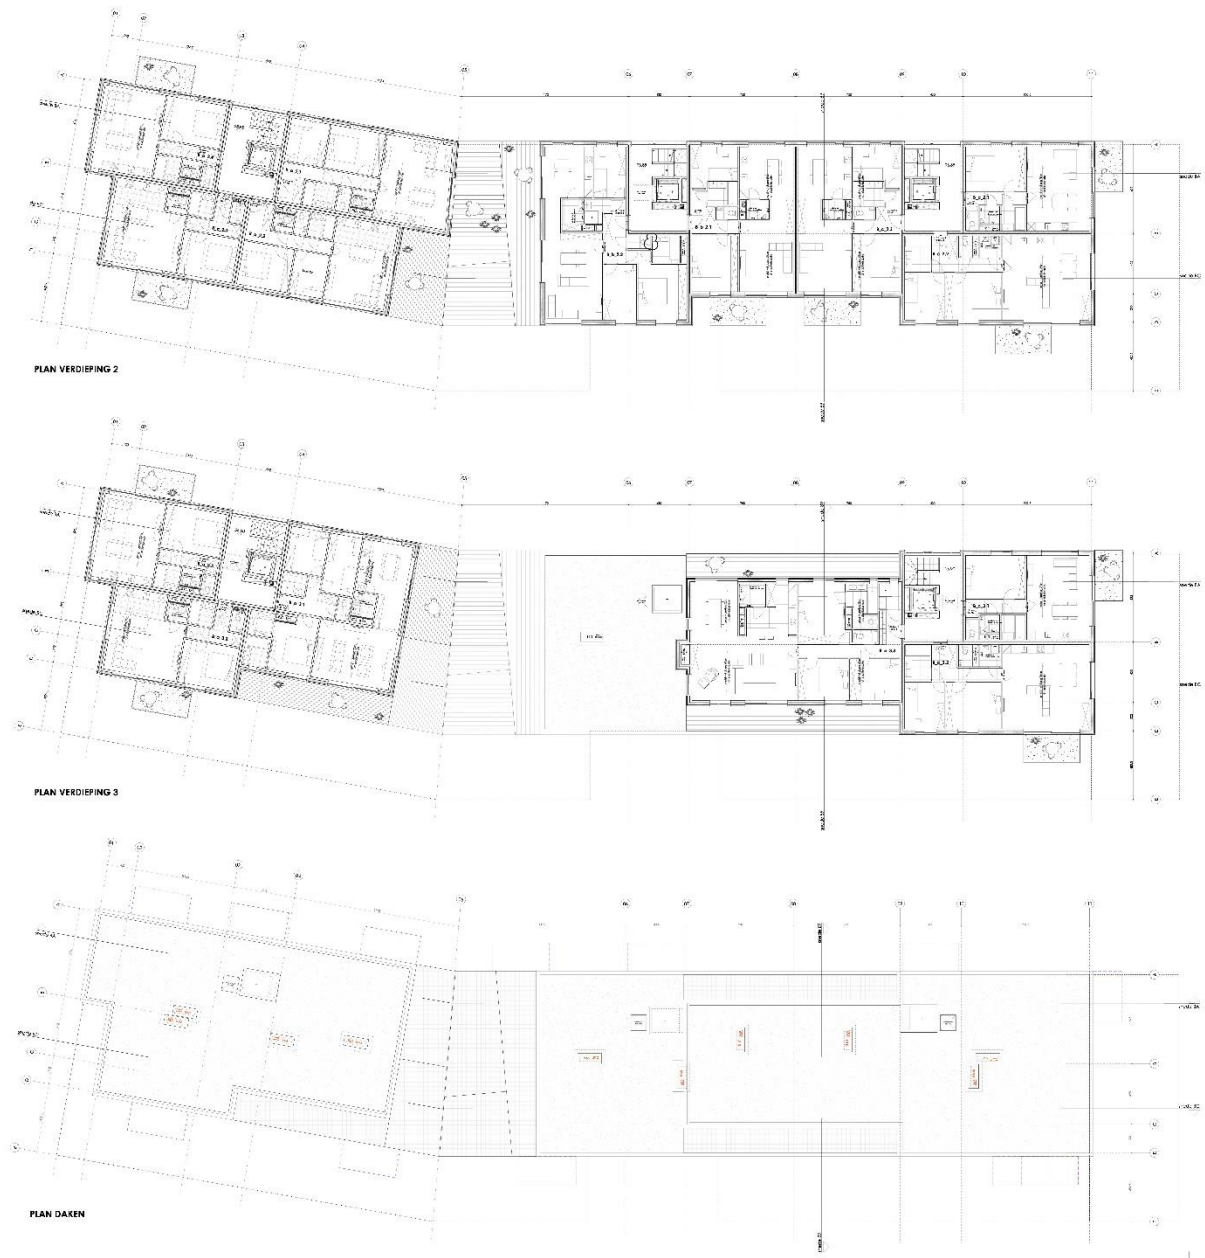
Detailplan en doorsnedes van de toekomstige implantatie DEEL A⁸
